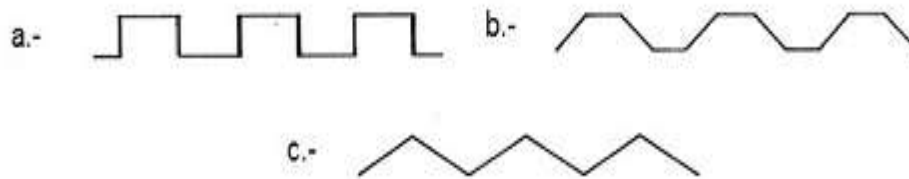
Secciones transversales de tipos básicos de losas plegadas.
